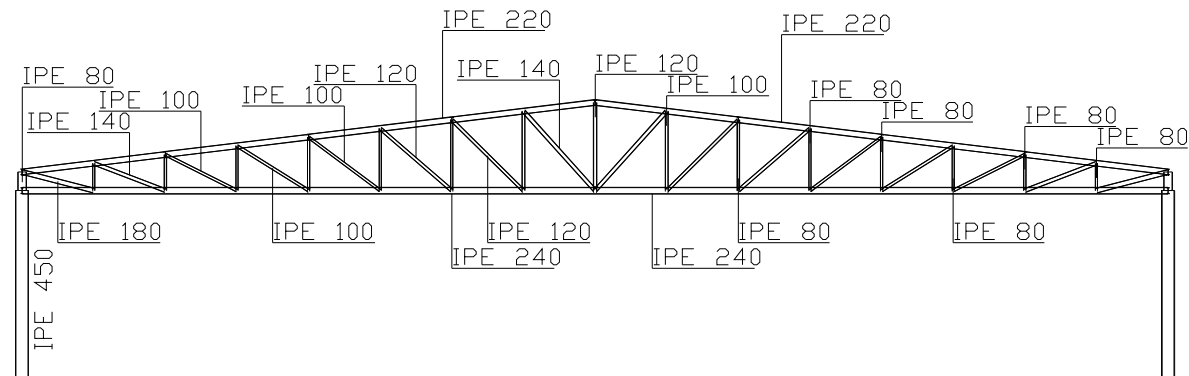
Pórtico com pilar de alma cheia, viga em treliça, vão de 40.00m, pilar e viga em perfil com secção transversal IPE.
